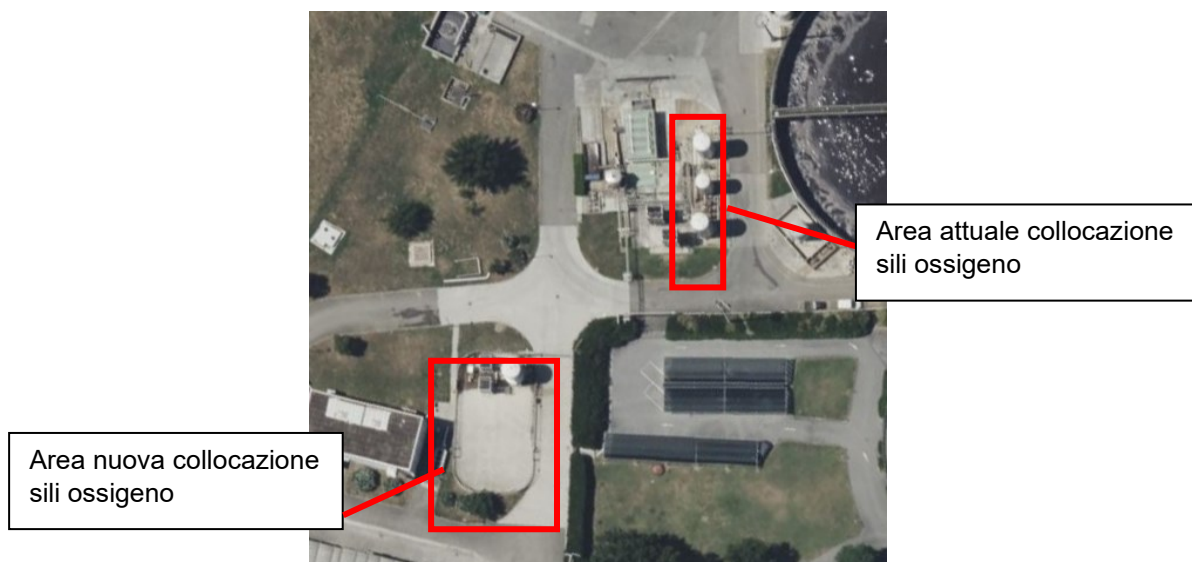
Individuazione area di intervento rispetto al Depuratore di Santa Croce sull'Arno
